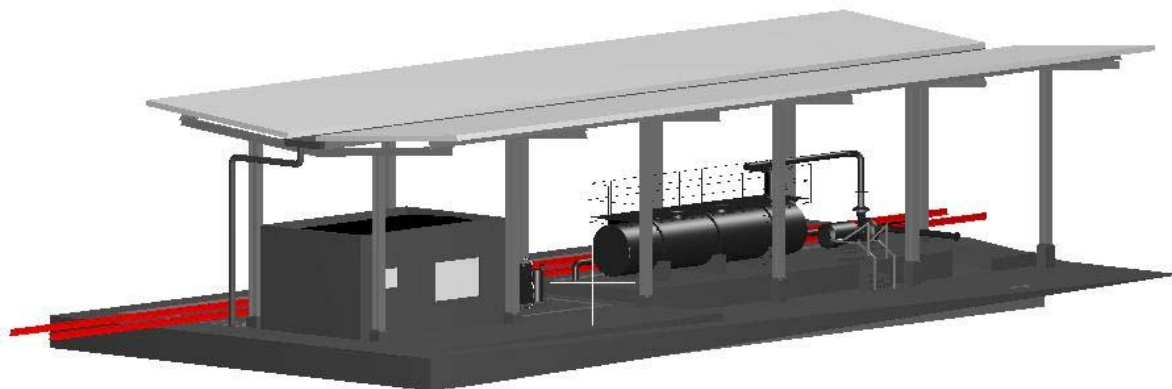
Modelo de ponto de abastecimento a ser implantado no escopo das instalações fixas
